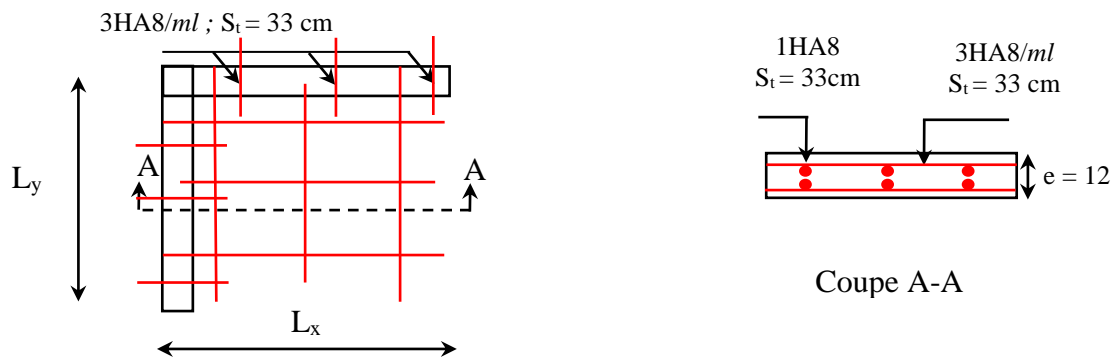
Schéma de ferrailage de la dalle D1 et D2
